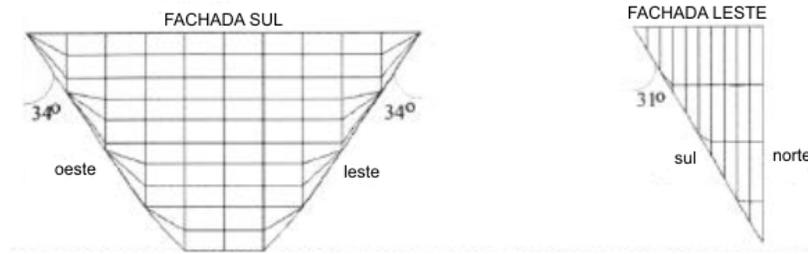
Fachada sul e fachada leste. Fonte: Capeluto, 2003
